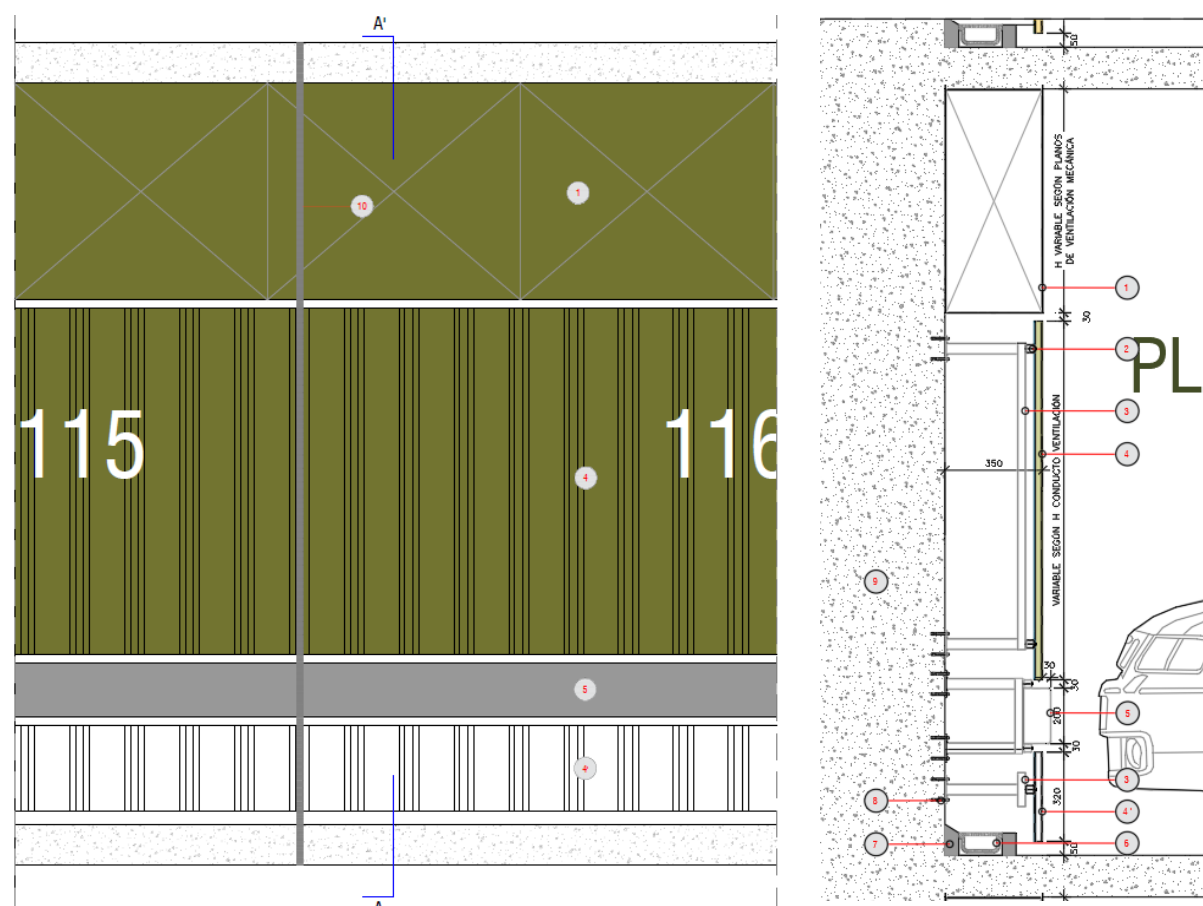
Reparación sistema de drenaje de los muros – alzado y sección-
